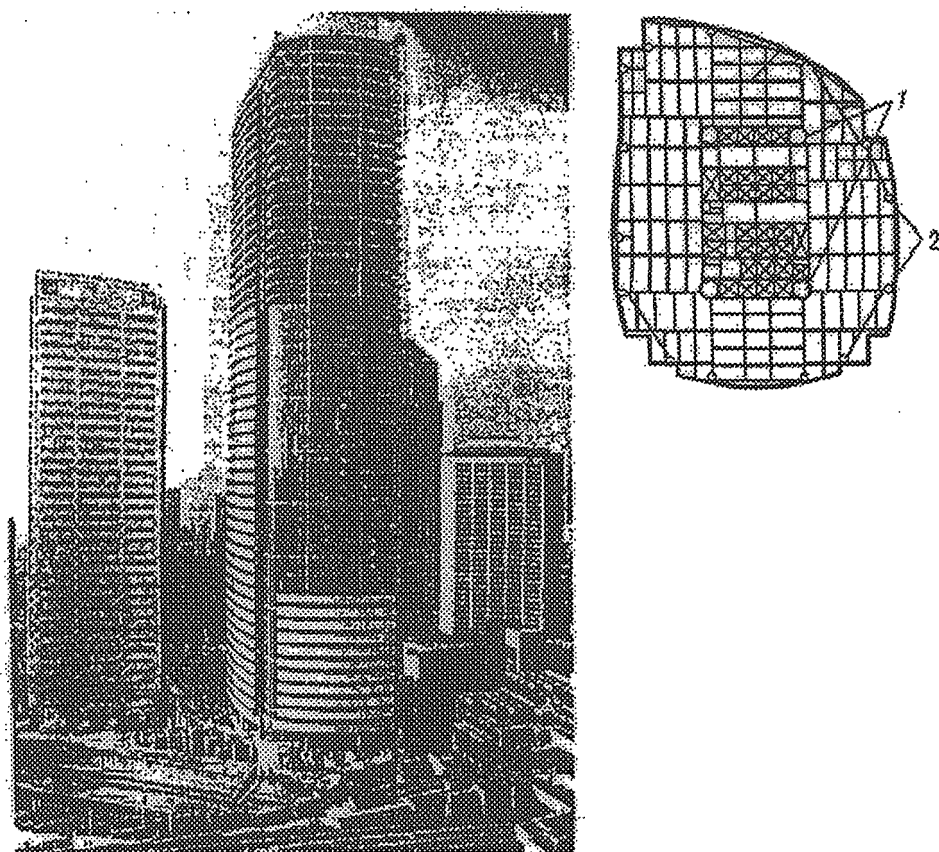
Общий вид и план типового этажа 58-этажного административного здания с труботетонными колоннами (1 - труботетонные колонны центрального ствола, 2 - контурные труботетонные колонны).
